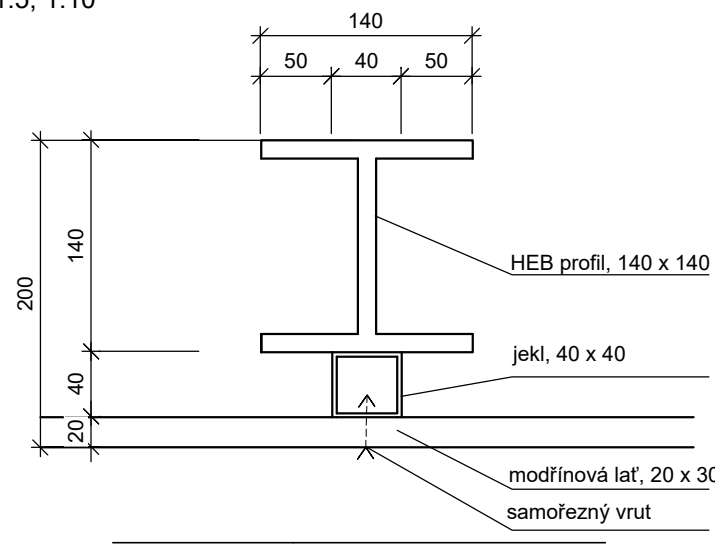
DETAILY SPOJŮ HEB PROFILŮ, M 1:5
